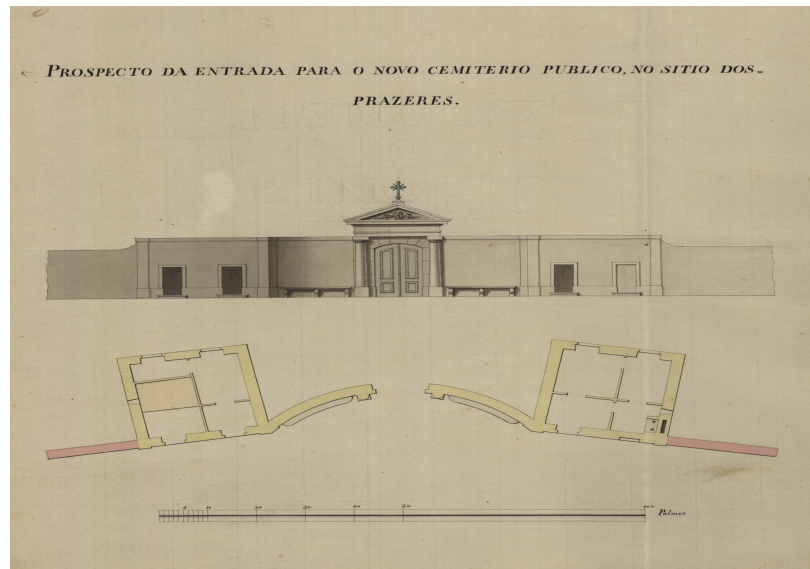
Planta e alçado da fachada do cemitério dos Prazeres
